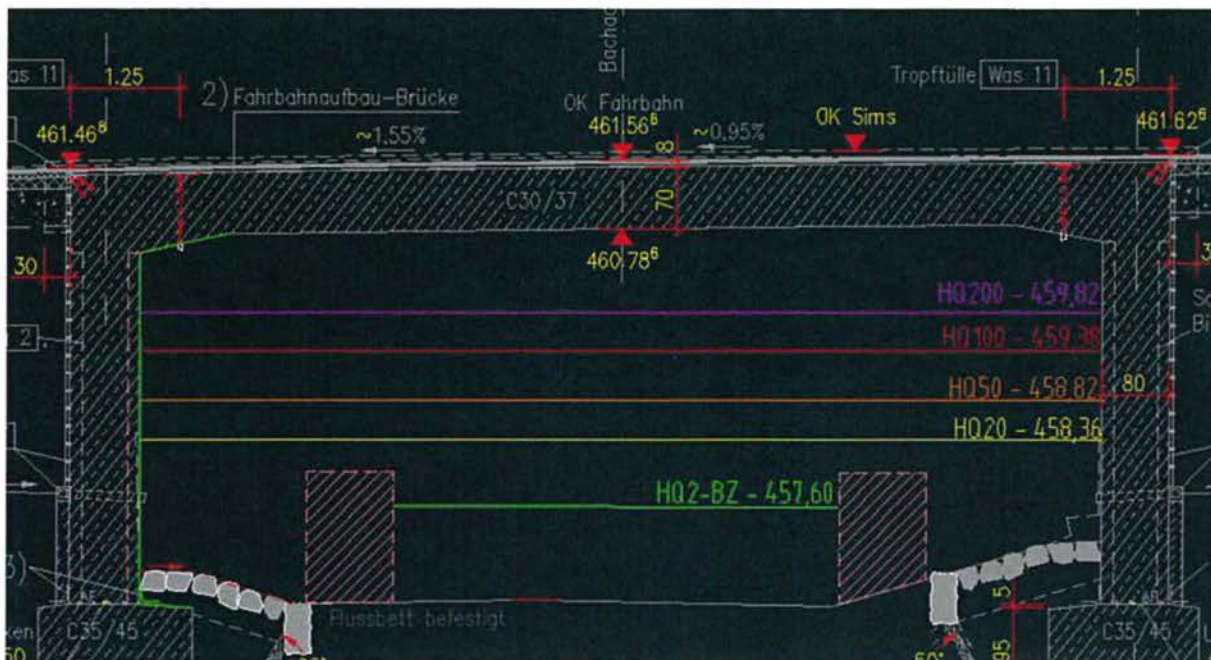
Wasserspiegellagen Bau- und Planzustand im Querschnitt für alle HQT
